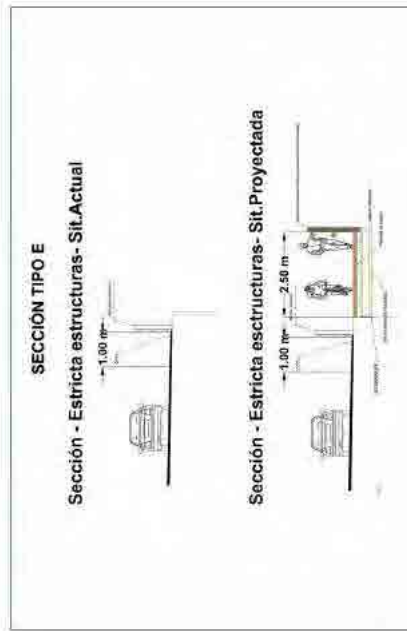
Sección tipo E, estructura en voladizo. (E: 2,50)
